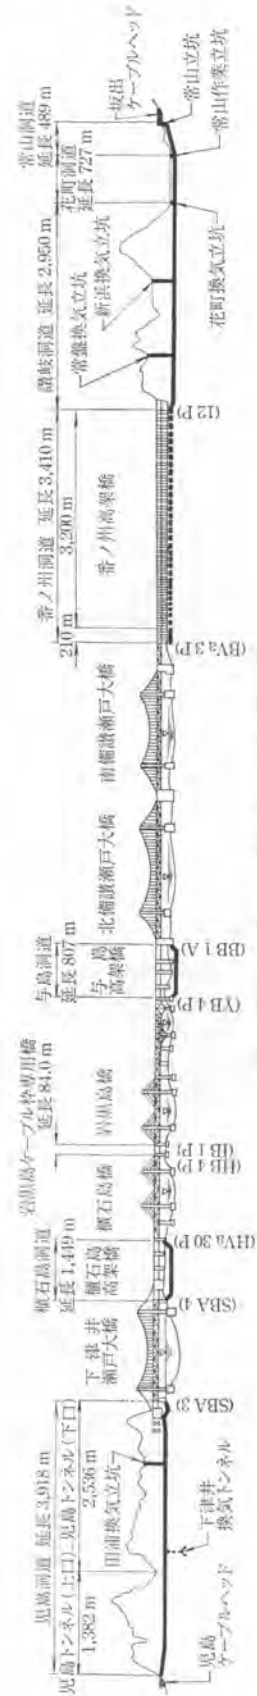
洞道およびケーブル橋梁添架概要図 (縦断面)
